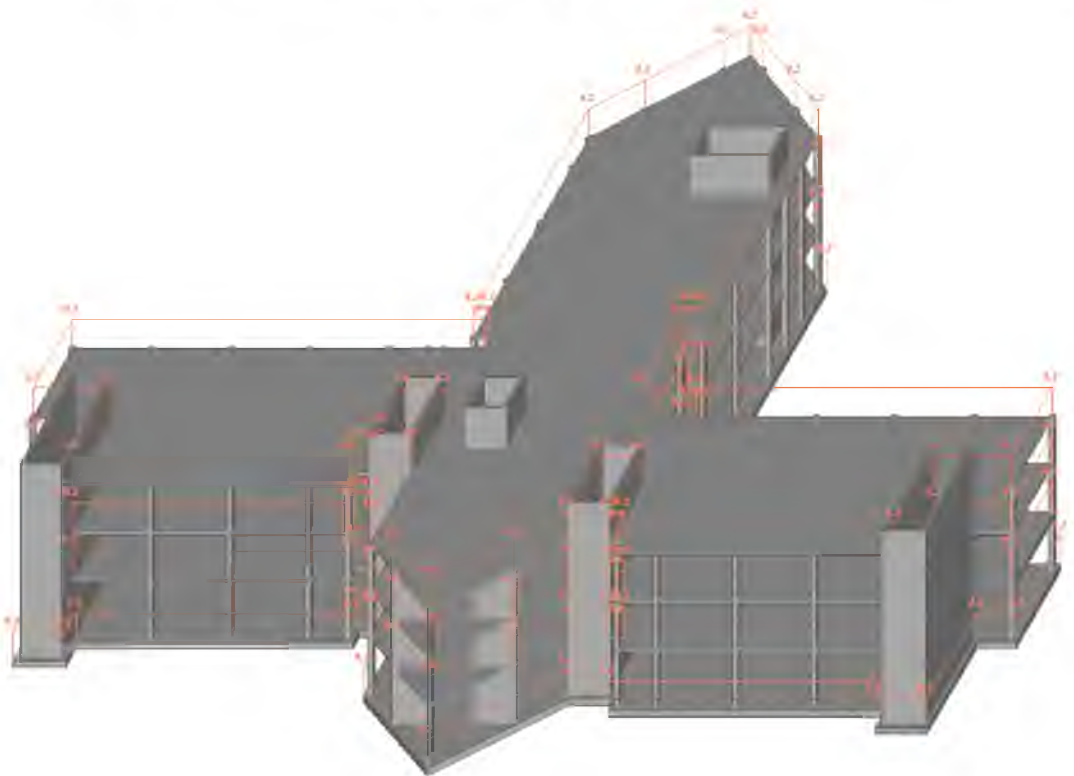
3D модель зі схемою прикладення будівлі навантажень
